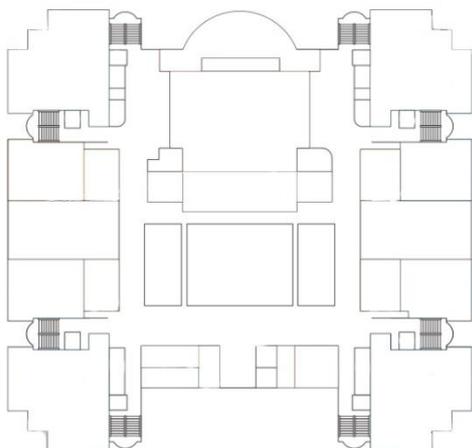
Plano planta baja una vez rehabilitado el edificio.
